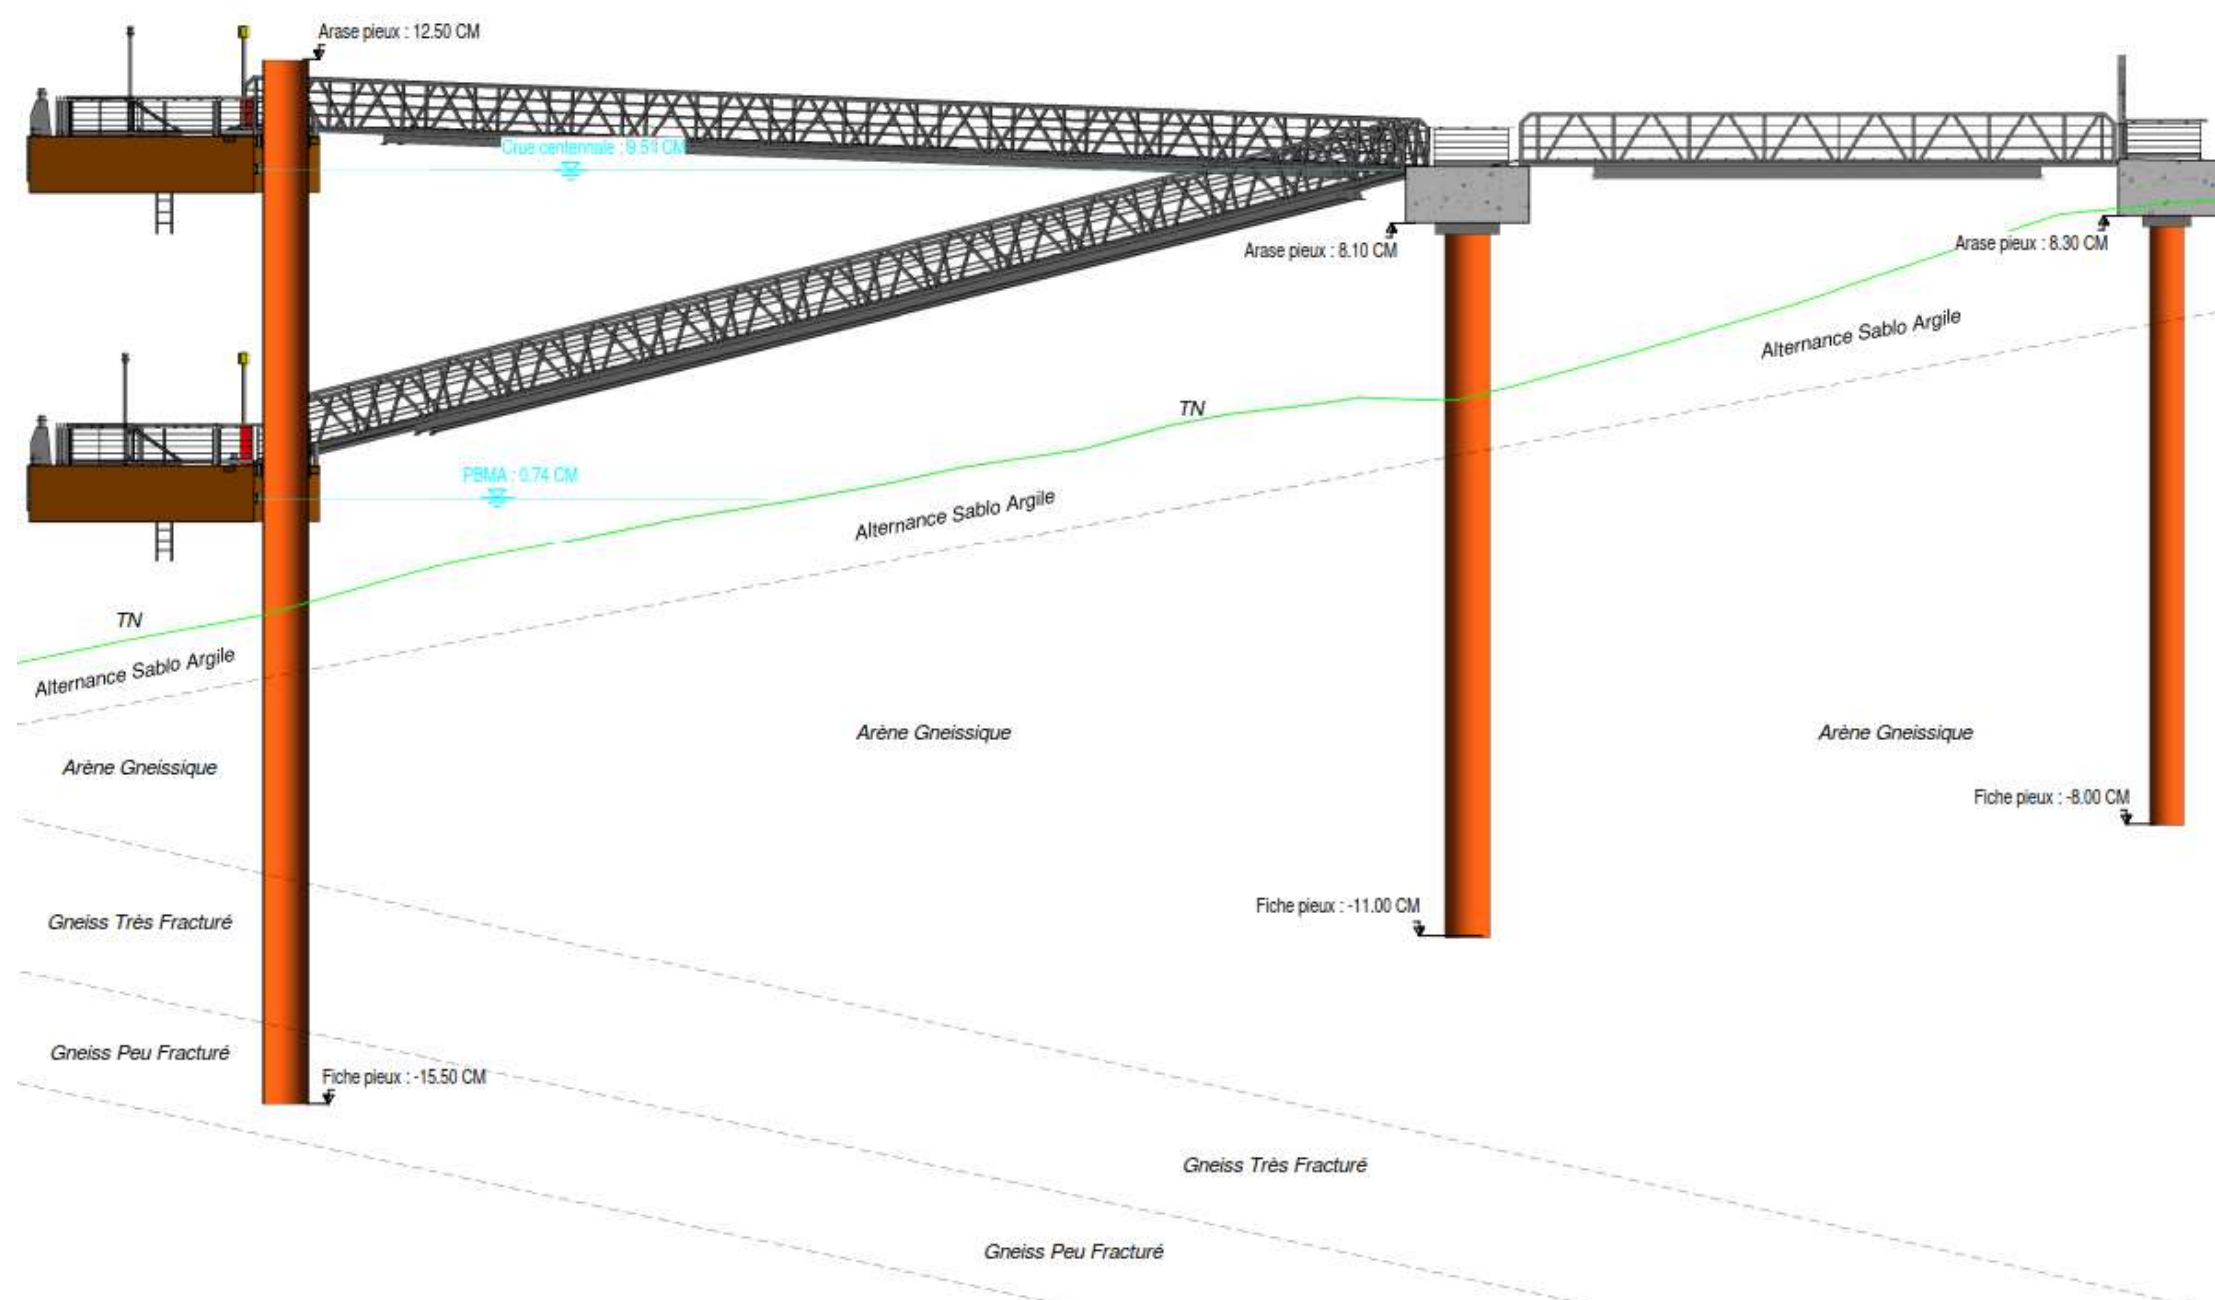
Plan détaillé des passerelles mobiles (Source : AVP)
